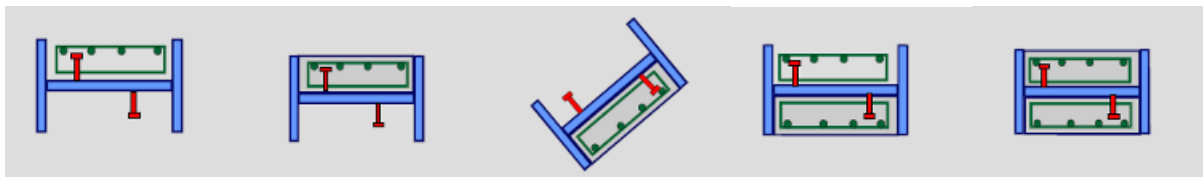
EXECUÇÃO DE UMA COLUNA PARCIALMENTE BETONADA
